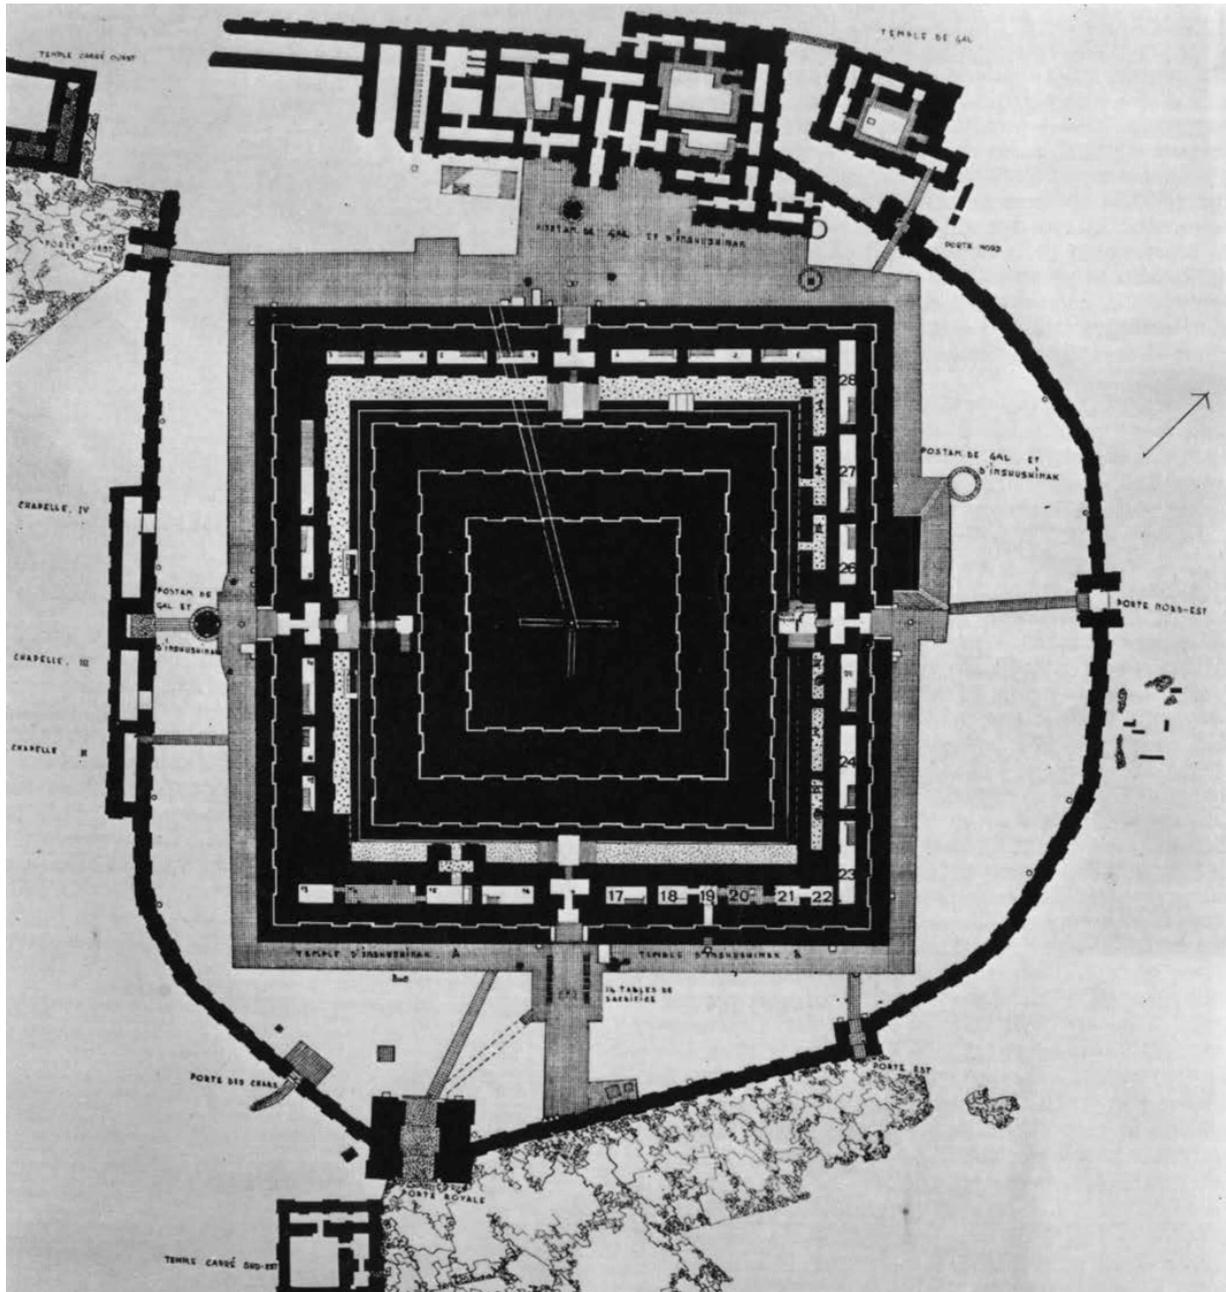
Pianta della ziggurat di Tchoga – Zanbil.
